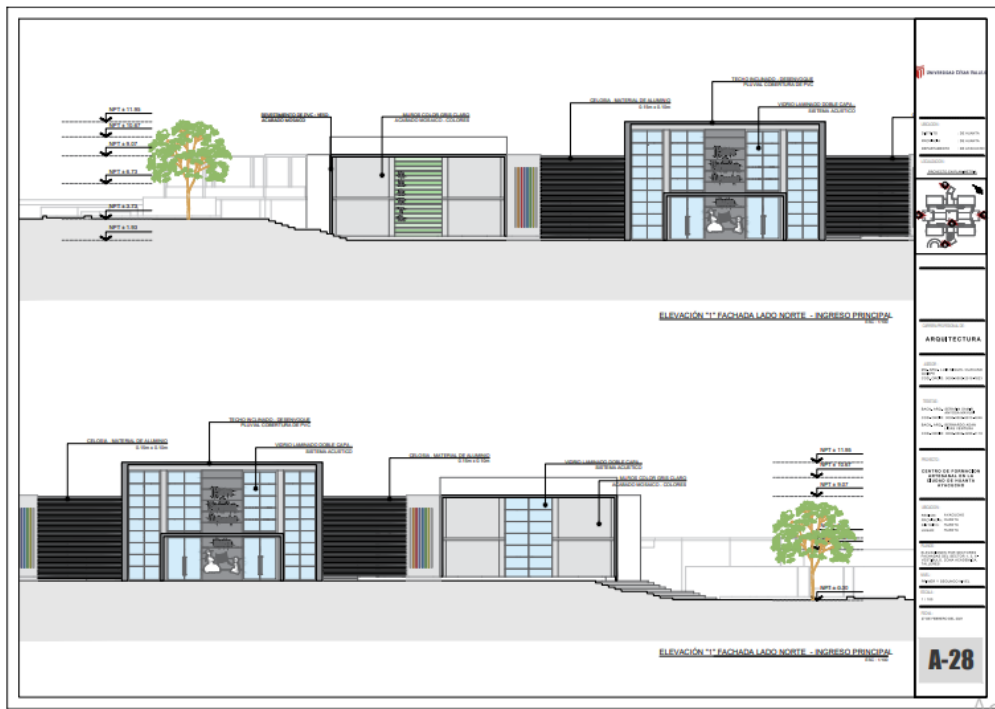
Elevaciones del lado norte – fachada principal escala 1/100.
